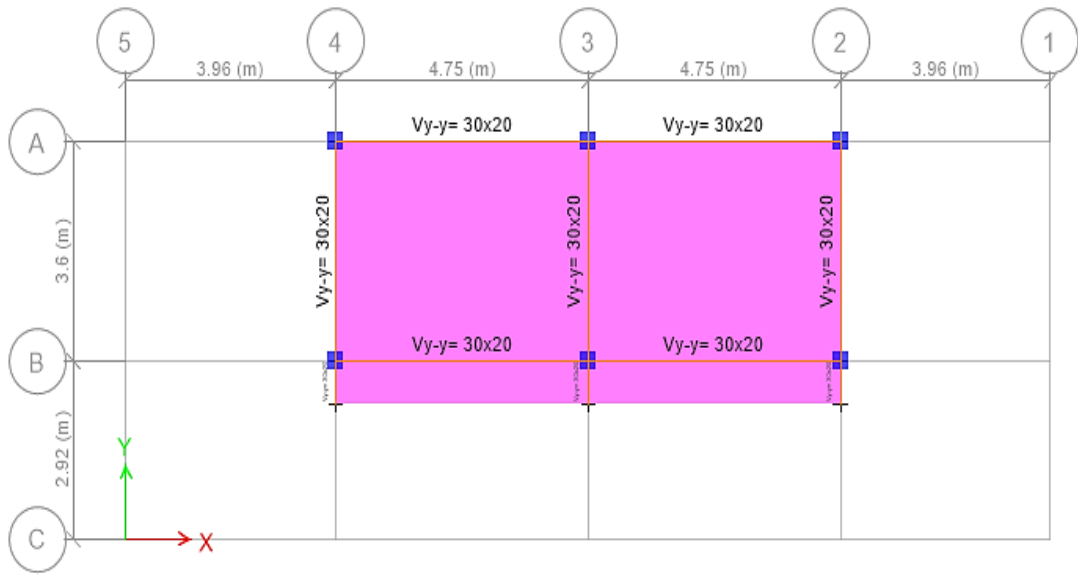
Vista en planta Nv. +2.88 y Nv. +5.58.
